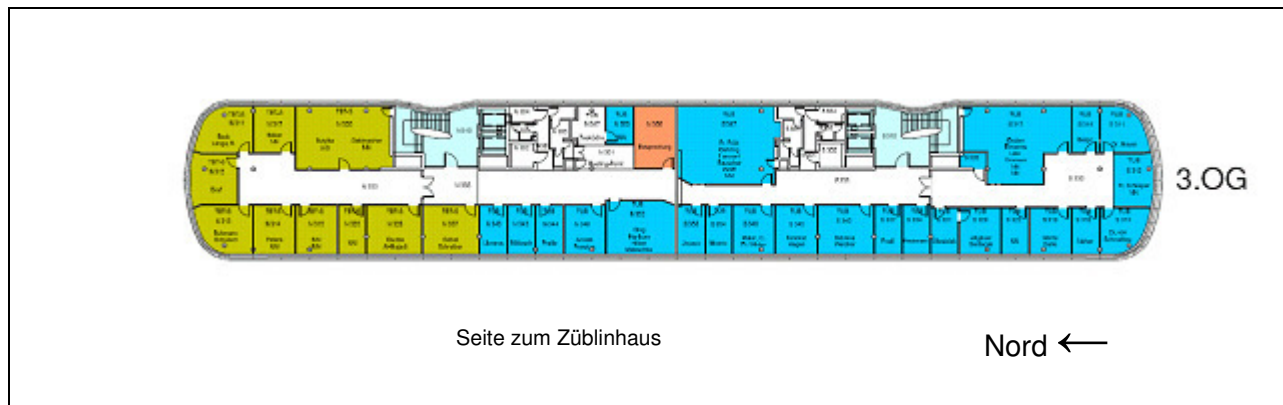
10: Standardgrundriss des Zzwo
